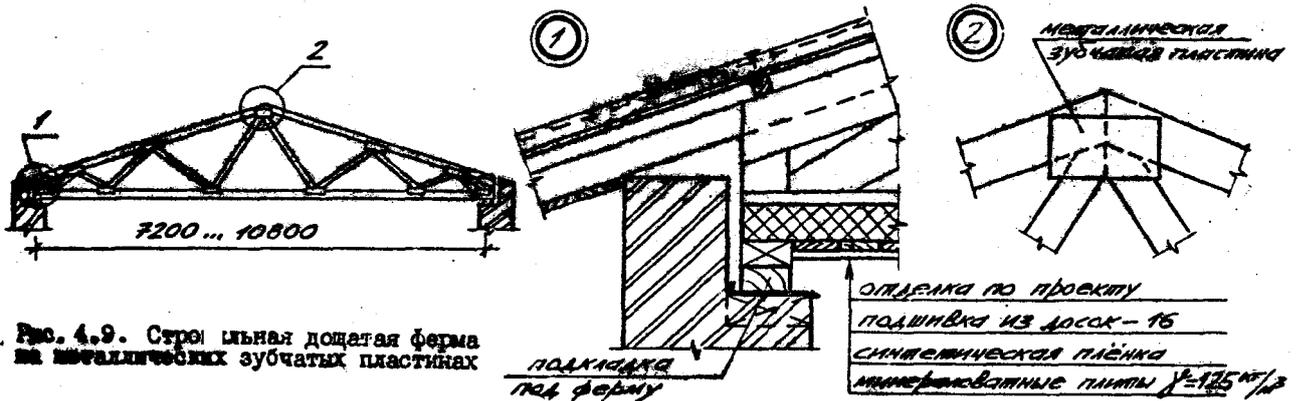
Стропильная дощатая ферма на металлических зубчатых пластинах
